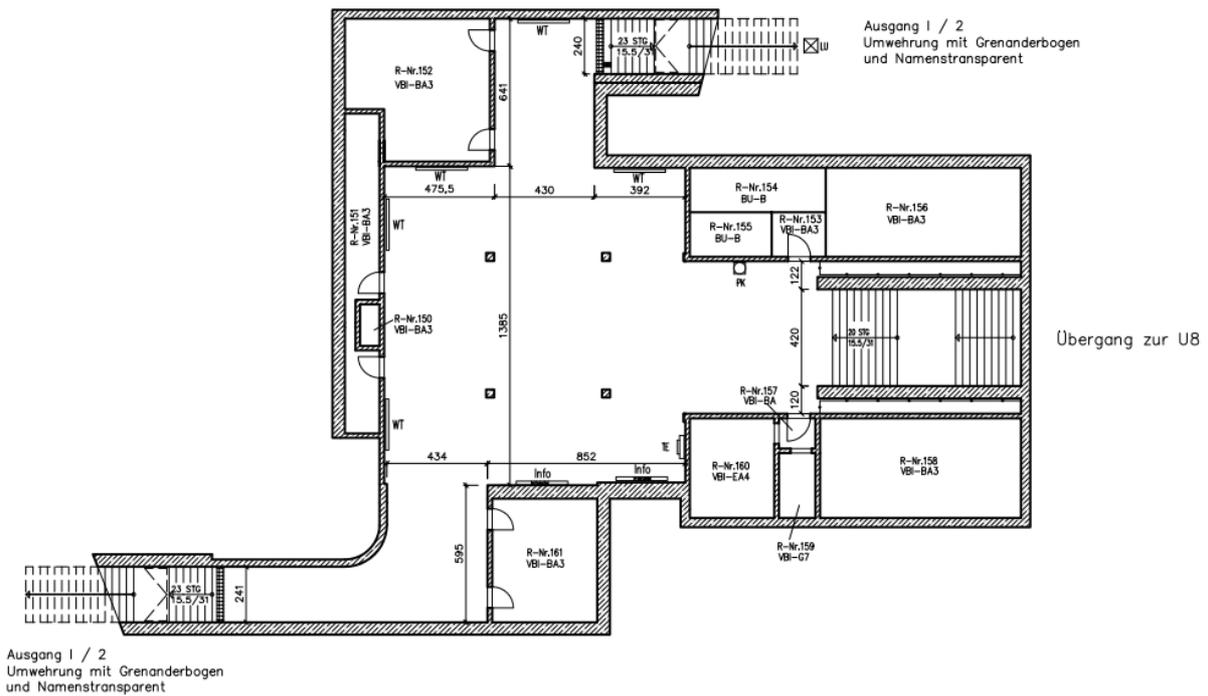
Grundriss Schalterhalle I, wird vollständig im Brandschutzkonzept betrachtet
